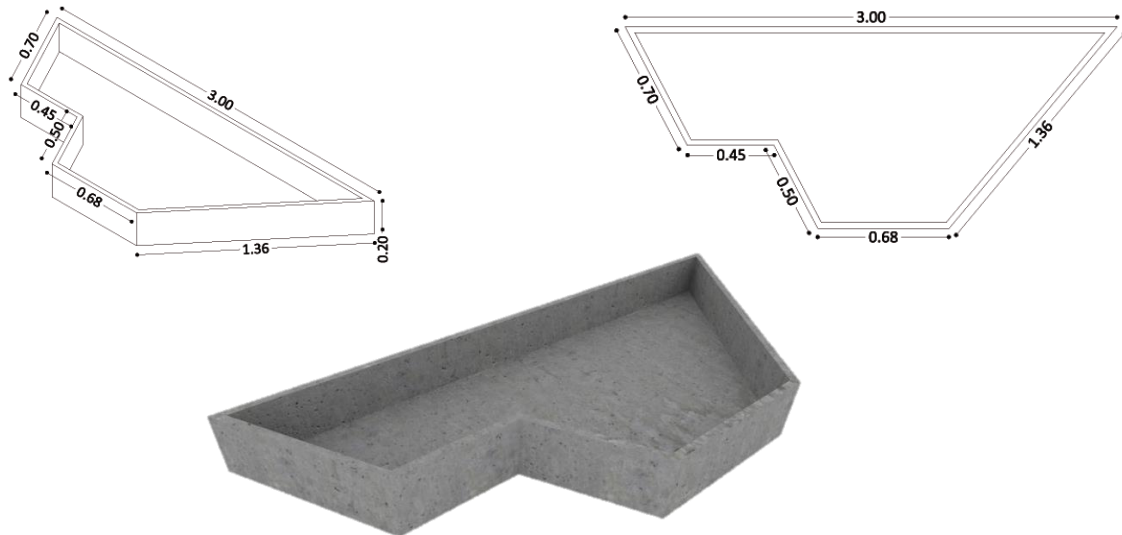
Planimetría y render, jardinera 1. Fuente: grupo de investigación.
